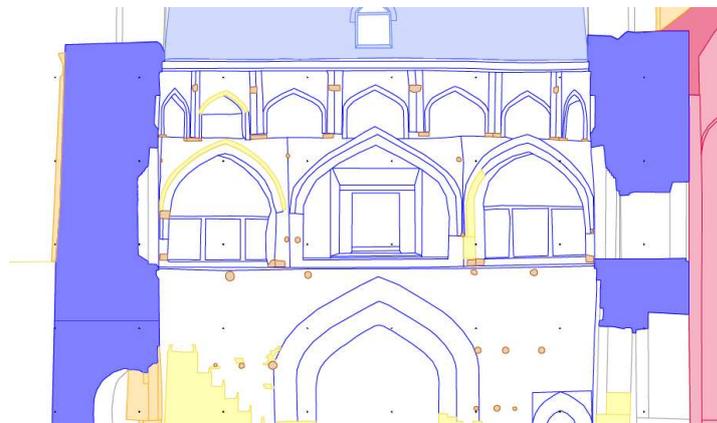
Plan - Iran_Borujerd_Baualterspläne-008.01_A2_Längsschnitt_1-100
